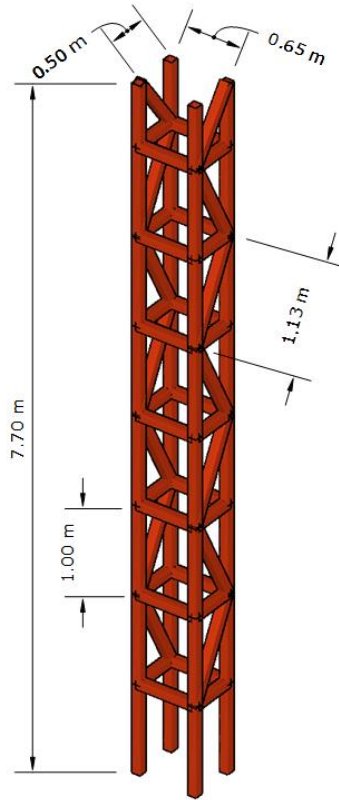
| *Columna de sección constante de pórtico tipo 1
